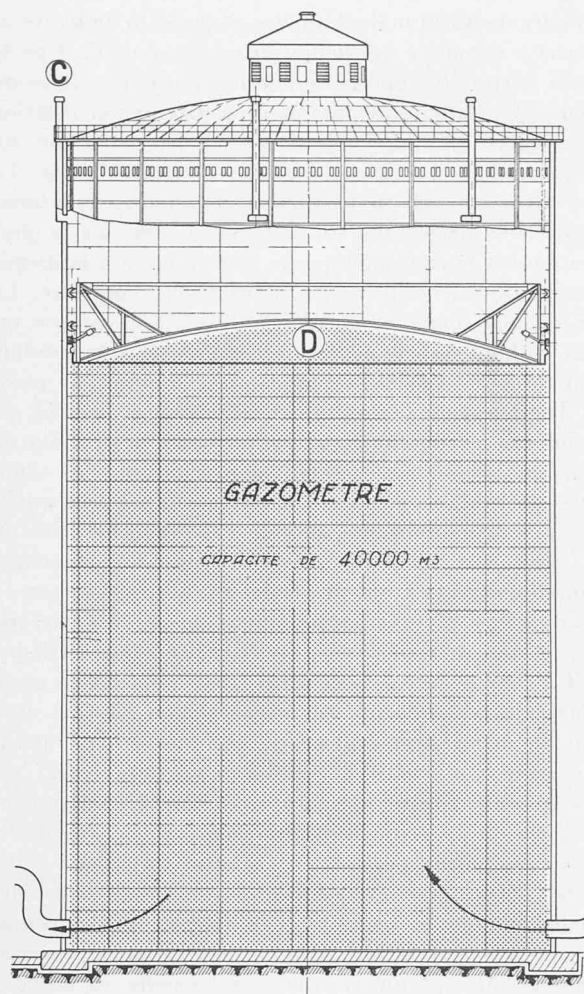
Coupe générale d'un gazomètre sec, syst. Klönne.
